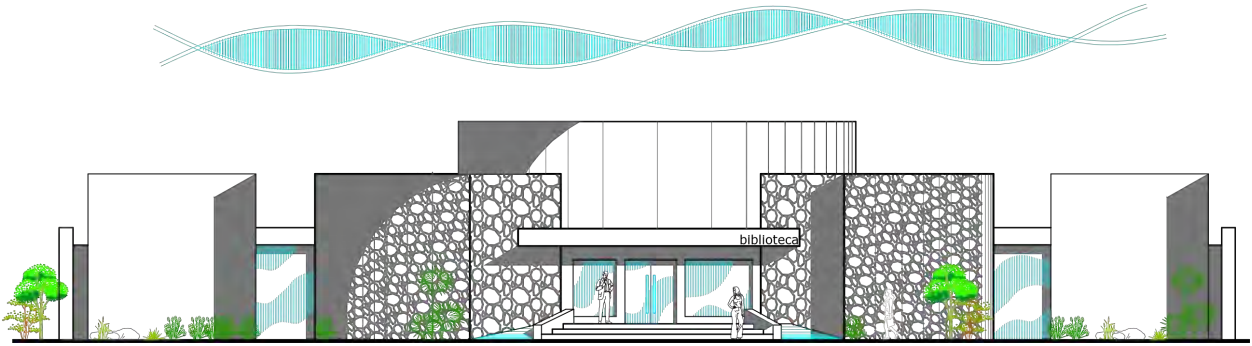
Fachada principal de la biblioteca donde se observan las paredes de piedra
